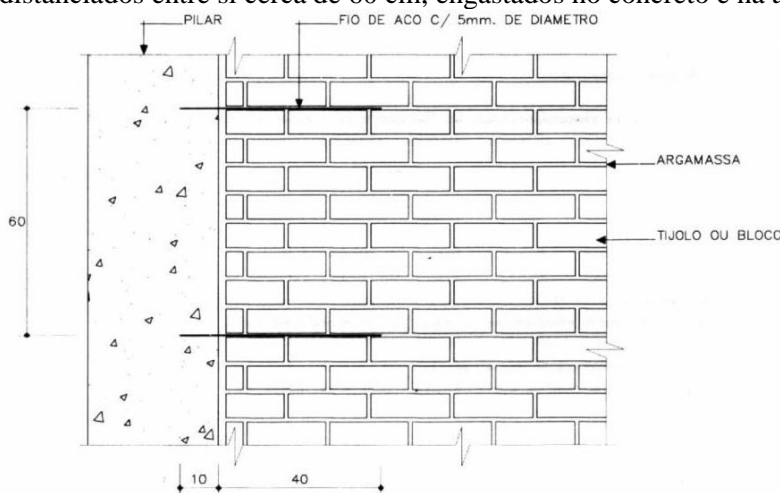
Detalhe ligação de alvenaria com pilares de concreto.
